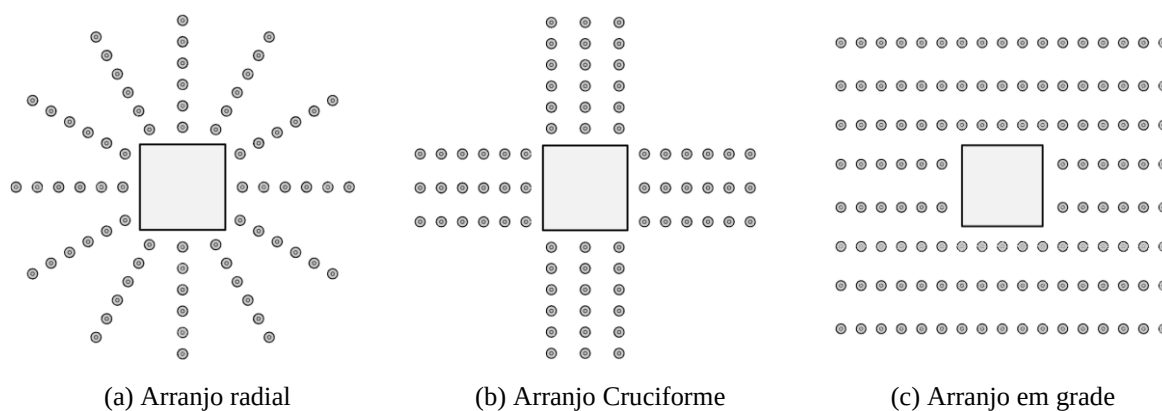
Tipos de arranjos das armaduras de cisalhamento
